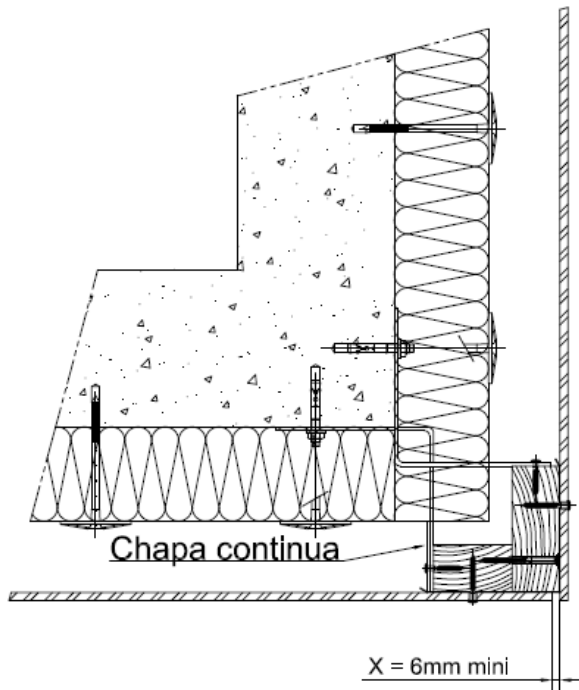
Sección horizontal. Detalle de esquina saliente.
